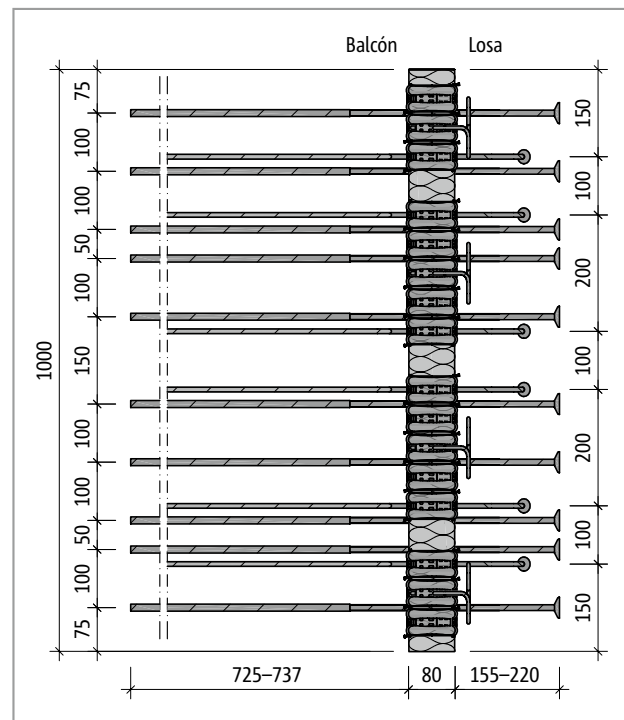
Schöck Isokorb® T tipo K-U-M4: Plano del producto
